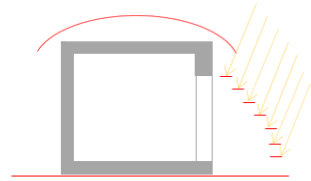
Elementos horizontales de protección solar. Fuente: Elaboración propia.
